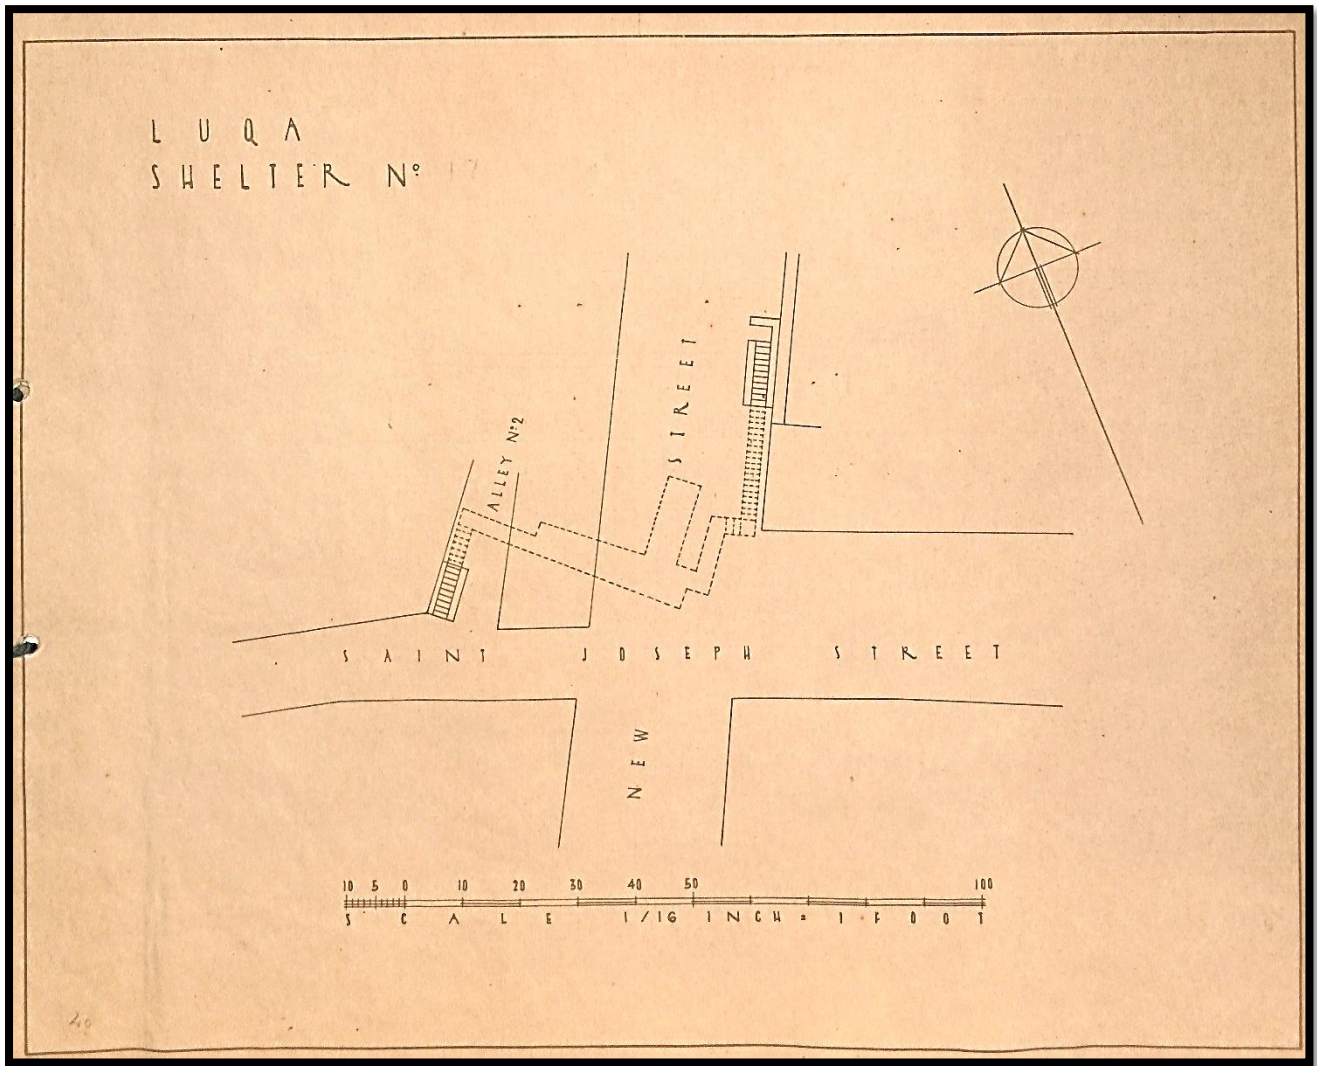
Planta do Abrigo nº17 "Saint Joseph Street – New Street – Alley nº1"
